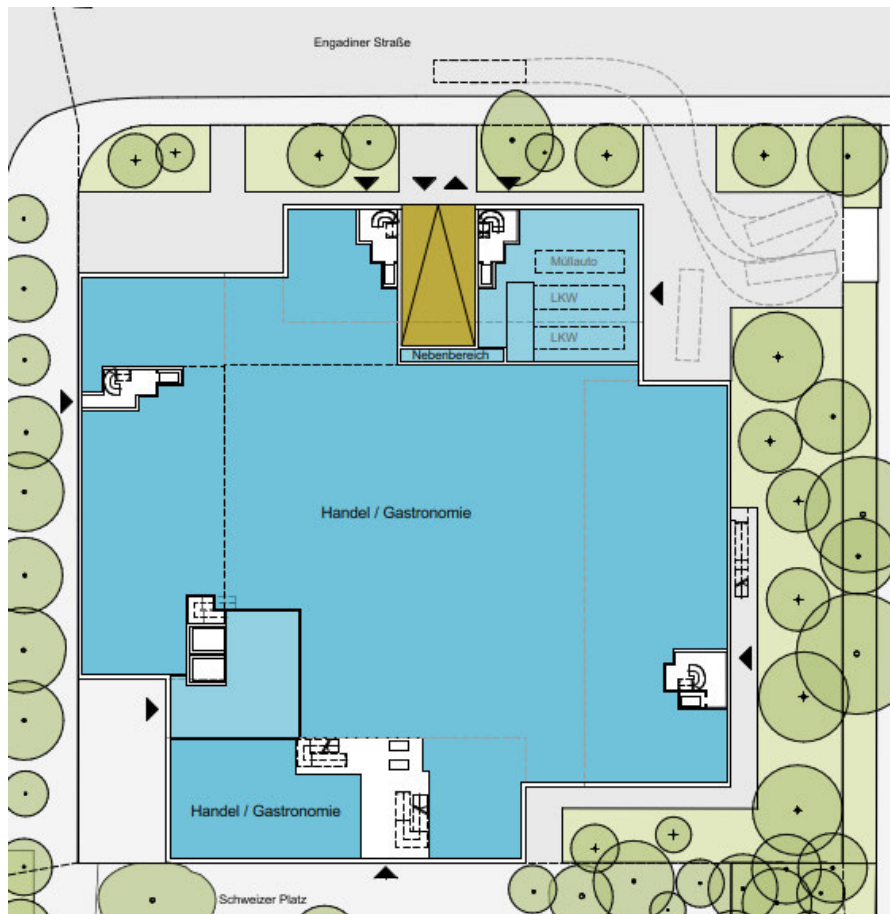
Auszug Grundriss EG mit geplanter TG-Zufahrt und Zufahrt Anlieferung [1]
